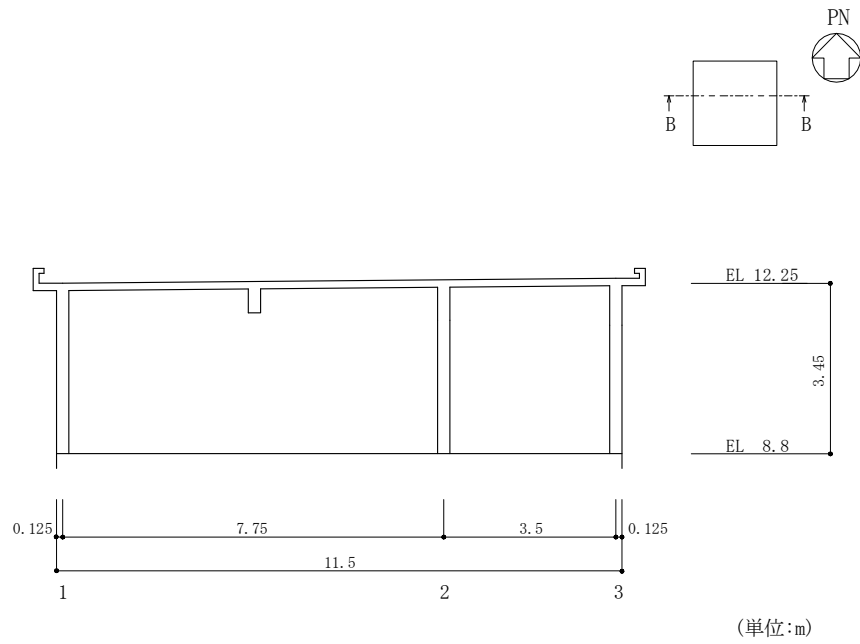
(2) 排気筒モニタ室の概略断面図 (B-B 断面, EW 方向)
